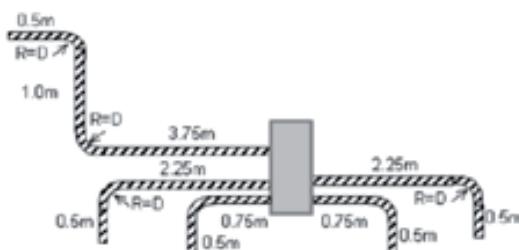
Dimensionado del sistema con flujo optimizado
